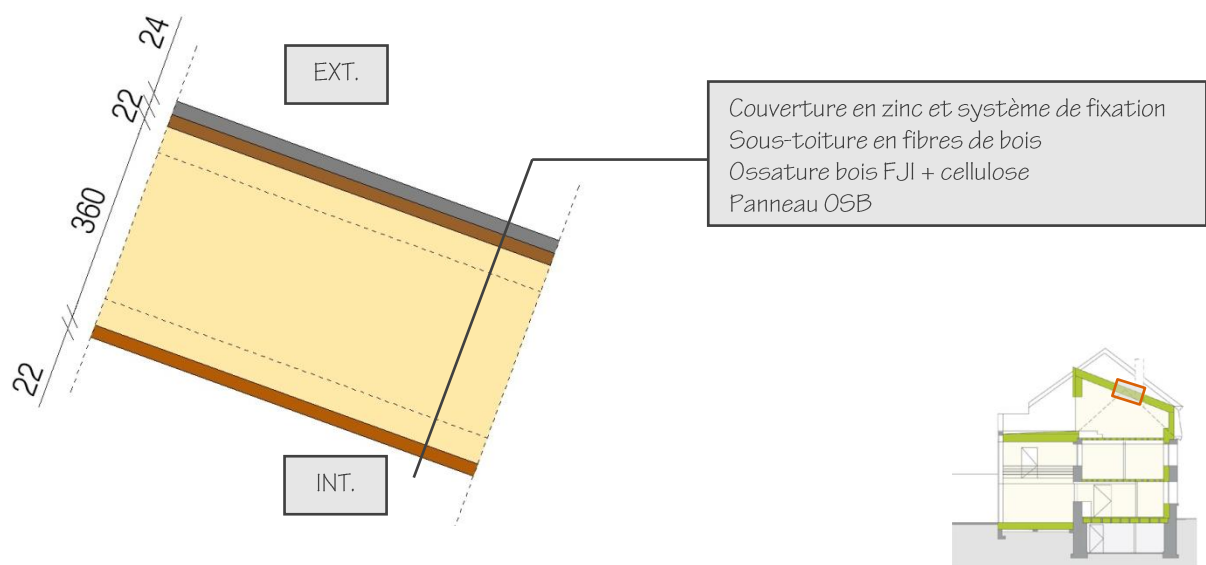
Détail de la toiture en pente du bâtiment principal, mesures en [mm]
